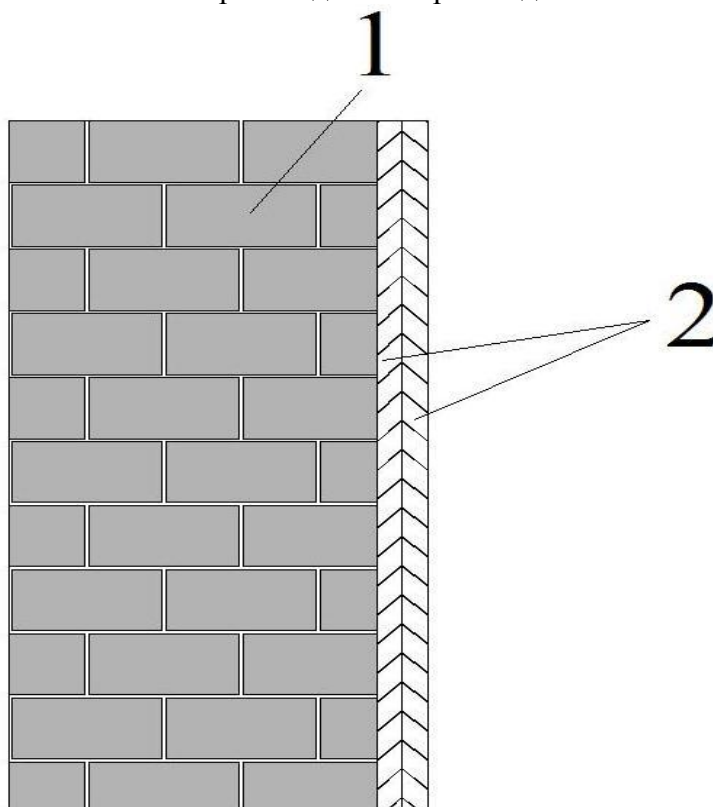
Гидроизоляция кирпичной и каменной кладки:
